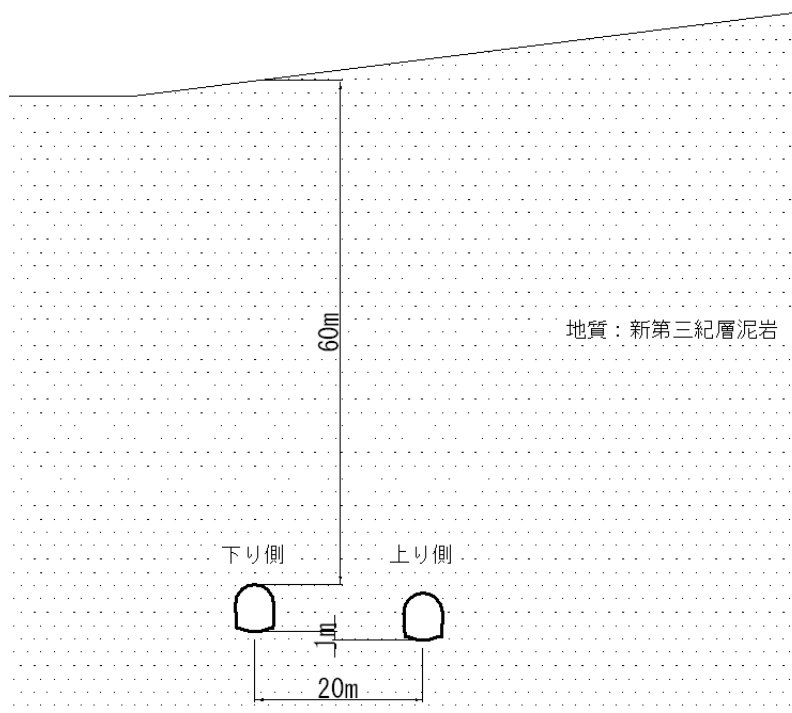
トンネル横断面略図（平面図 A-A'断面）
